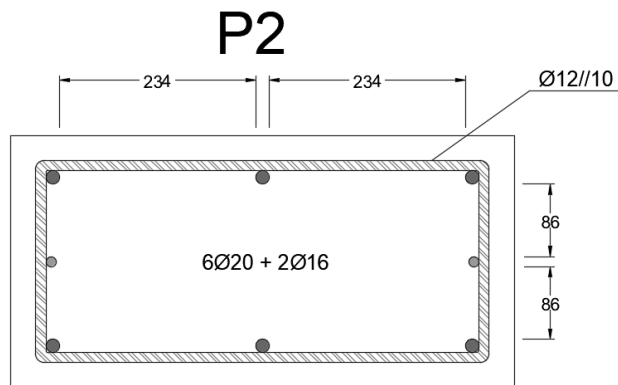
Armadura longitudinal e transversal do P2 para zonas críticas.
